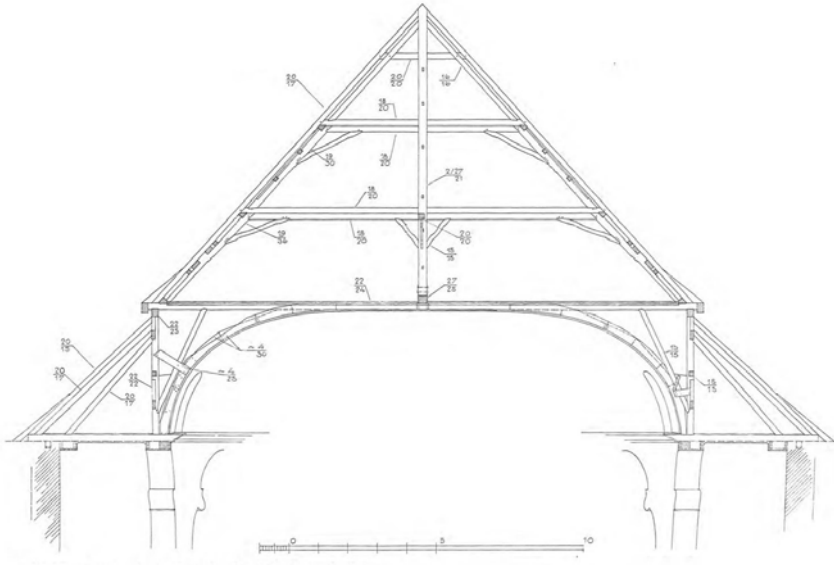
Querschnitt Hauptdachwerk der Wallfahrtskirche in der Wies
